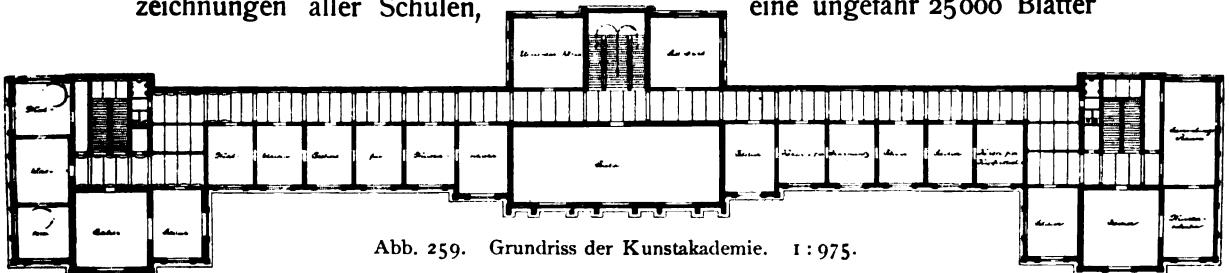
Grundriss der Kunstakademie. 1:975.
